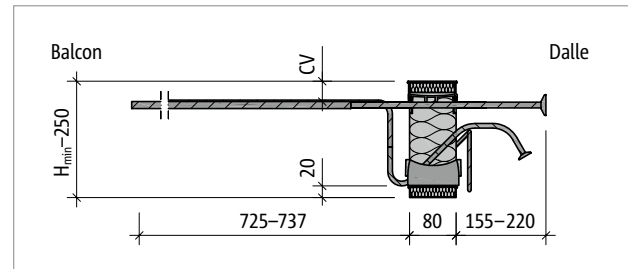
Schöck Isokorb® T type K-U-M4 : coupe du produit
